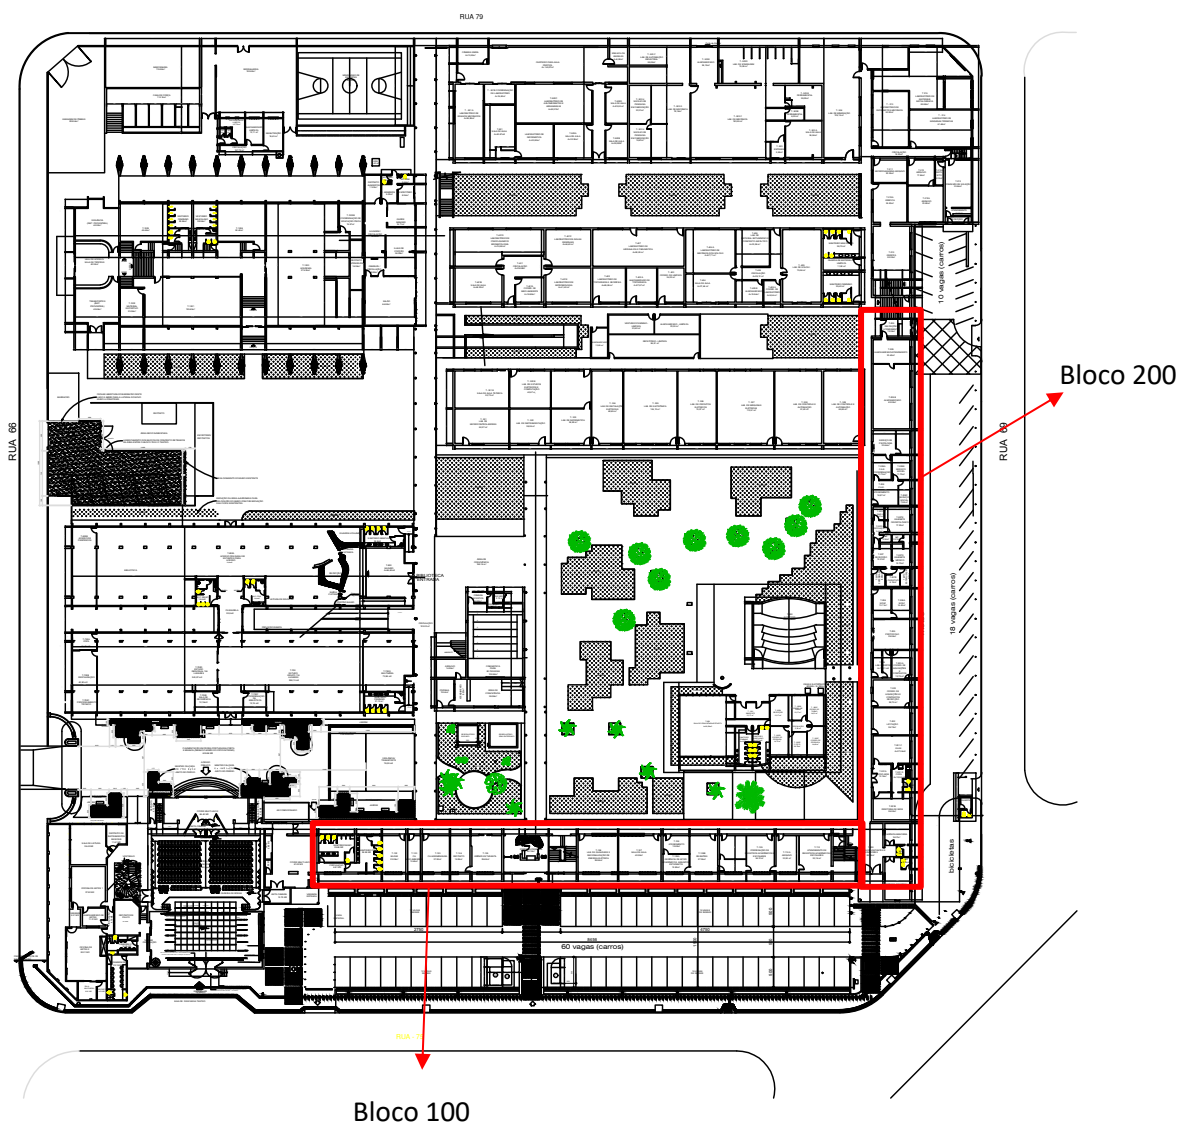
Instituto Federal de Goiás – Blocos 100 e 200 Pavimento Térreo. Fonte: Projeto arquitetônico.
